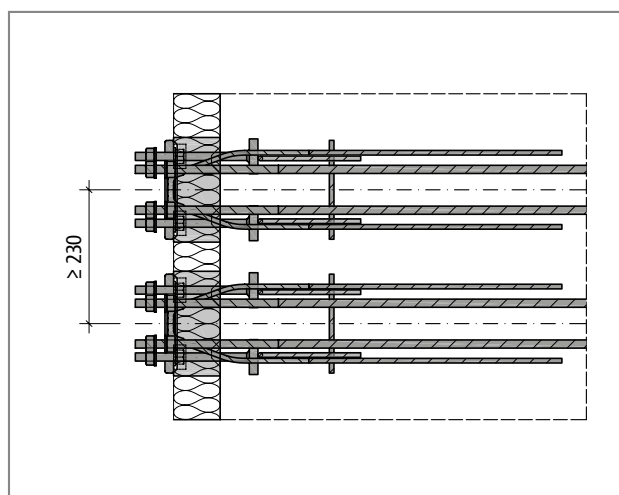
Schöck Isokorb® T tipo SKP: distanza assiale
